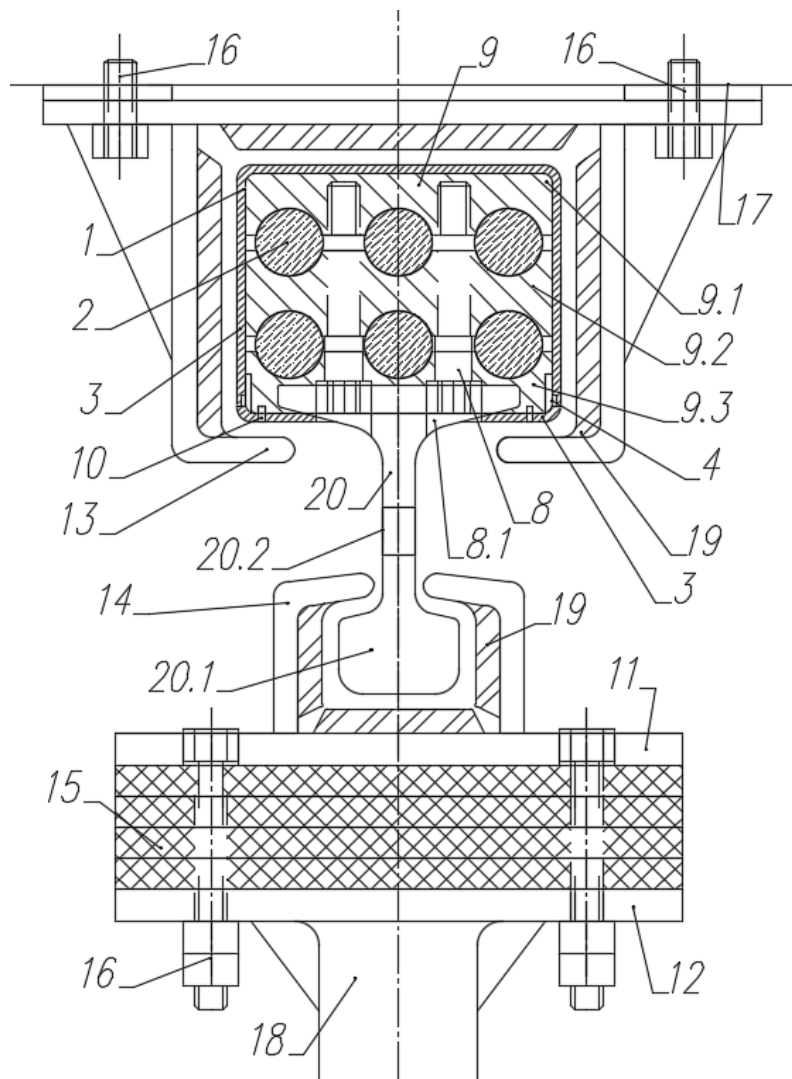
КПП с предохранительными лапами и соединение с расстрелом:
